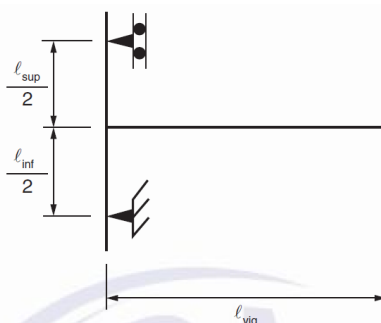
Vigas + Pilares (ABNT NBR 6118:2014)
